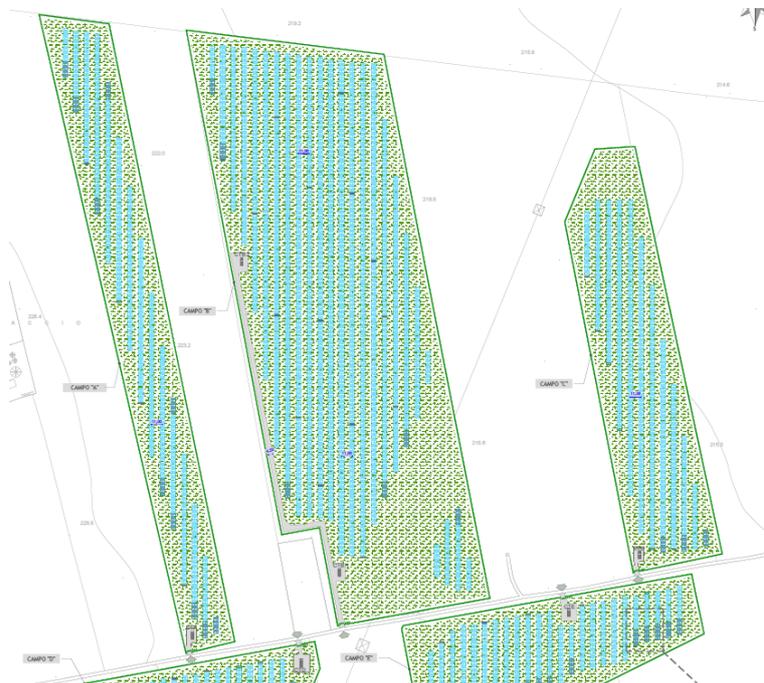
Planimetria dell'Impianto Fotovoltaico – Campi A, B, C
